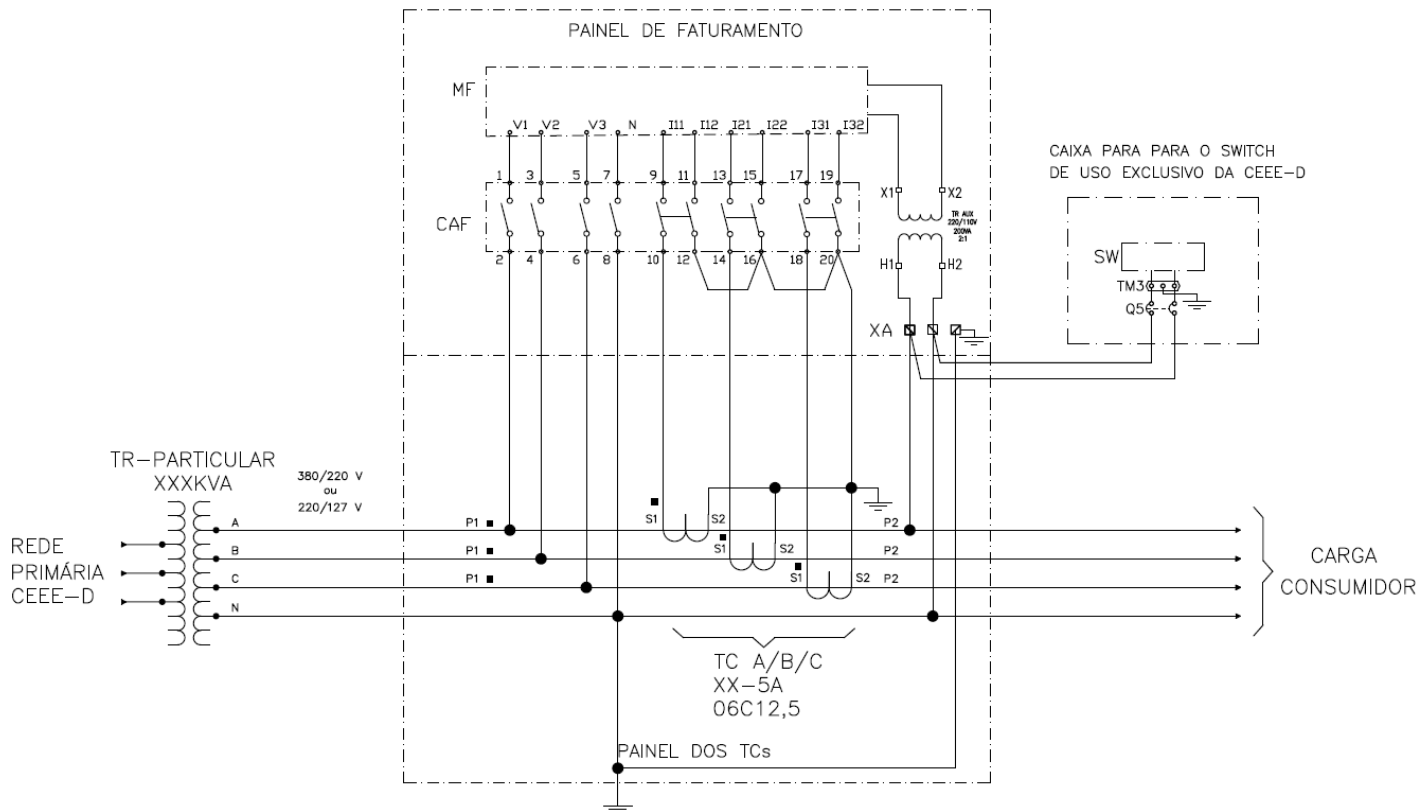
Disposição dos Equipamentos - PAINEL DE MEDIÇÃO BT
